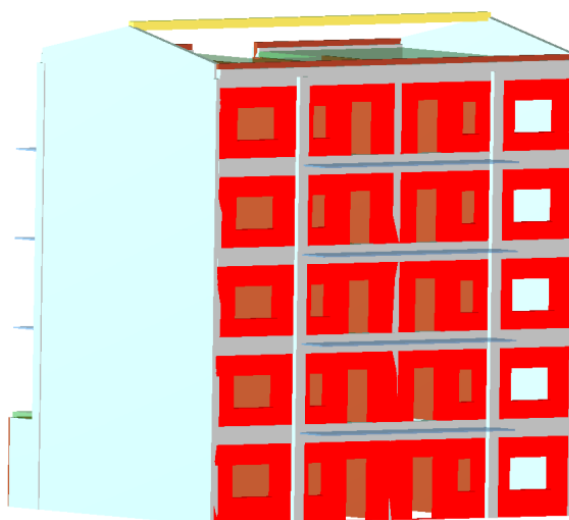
Esquema da execução de reboco armado nas duas faces da fachada de tardoz
